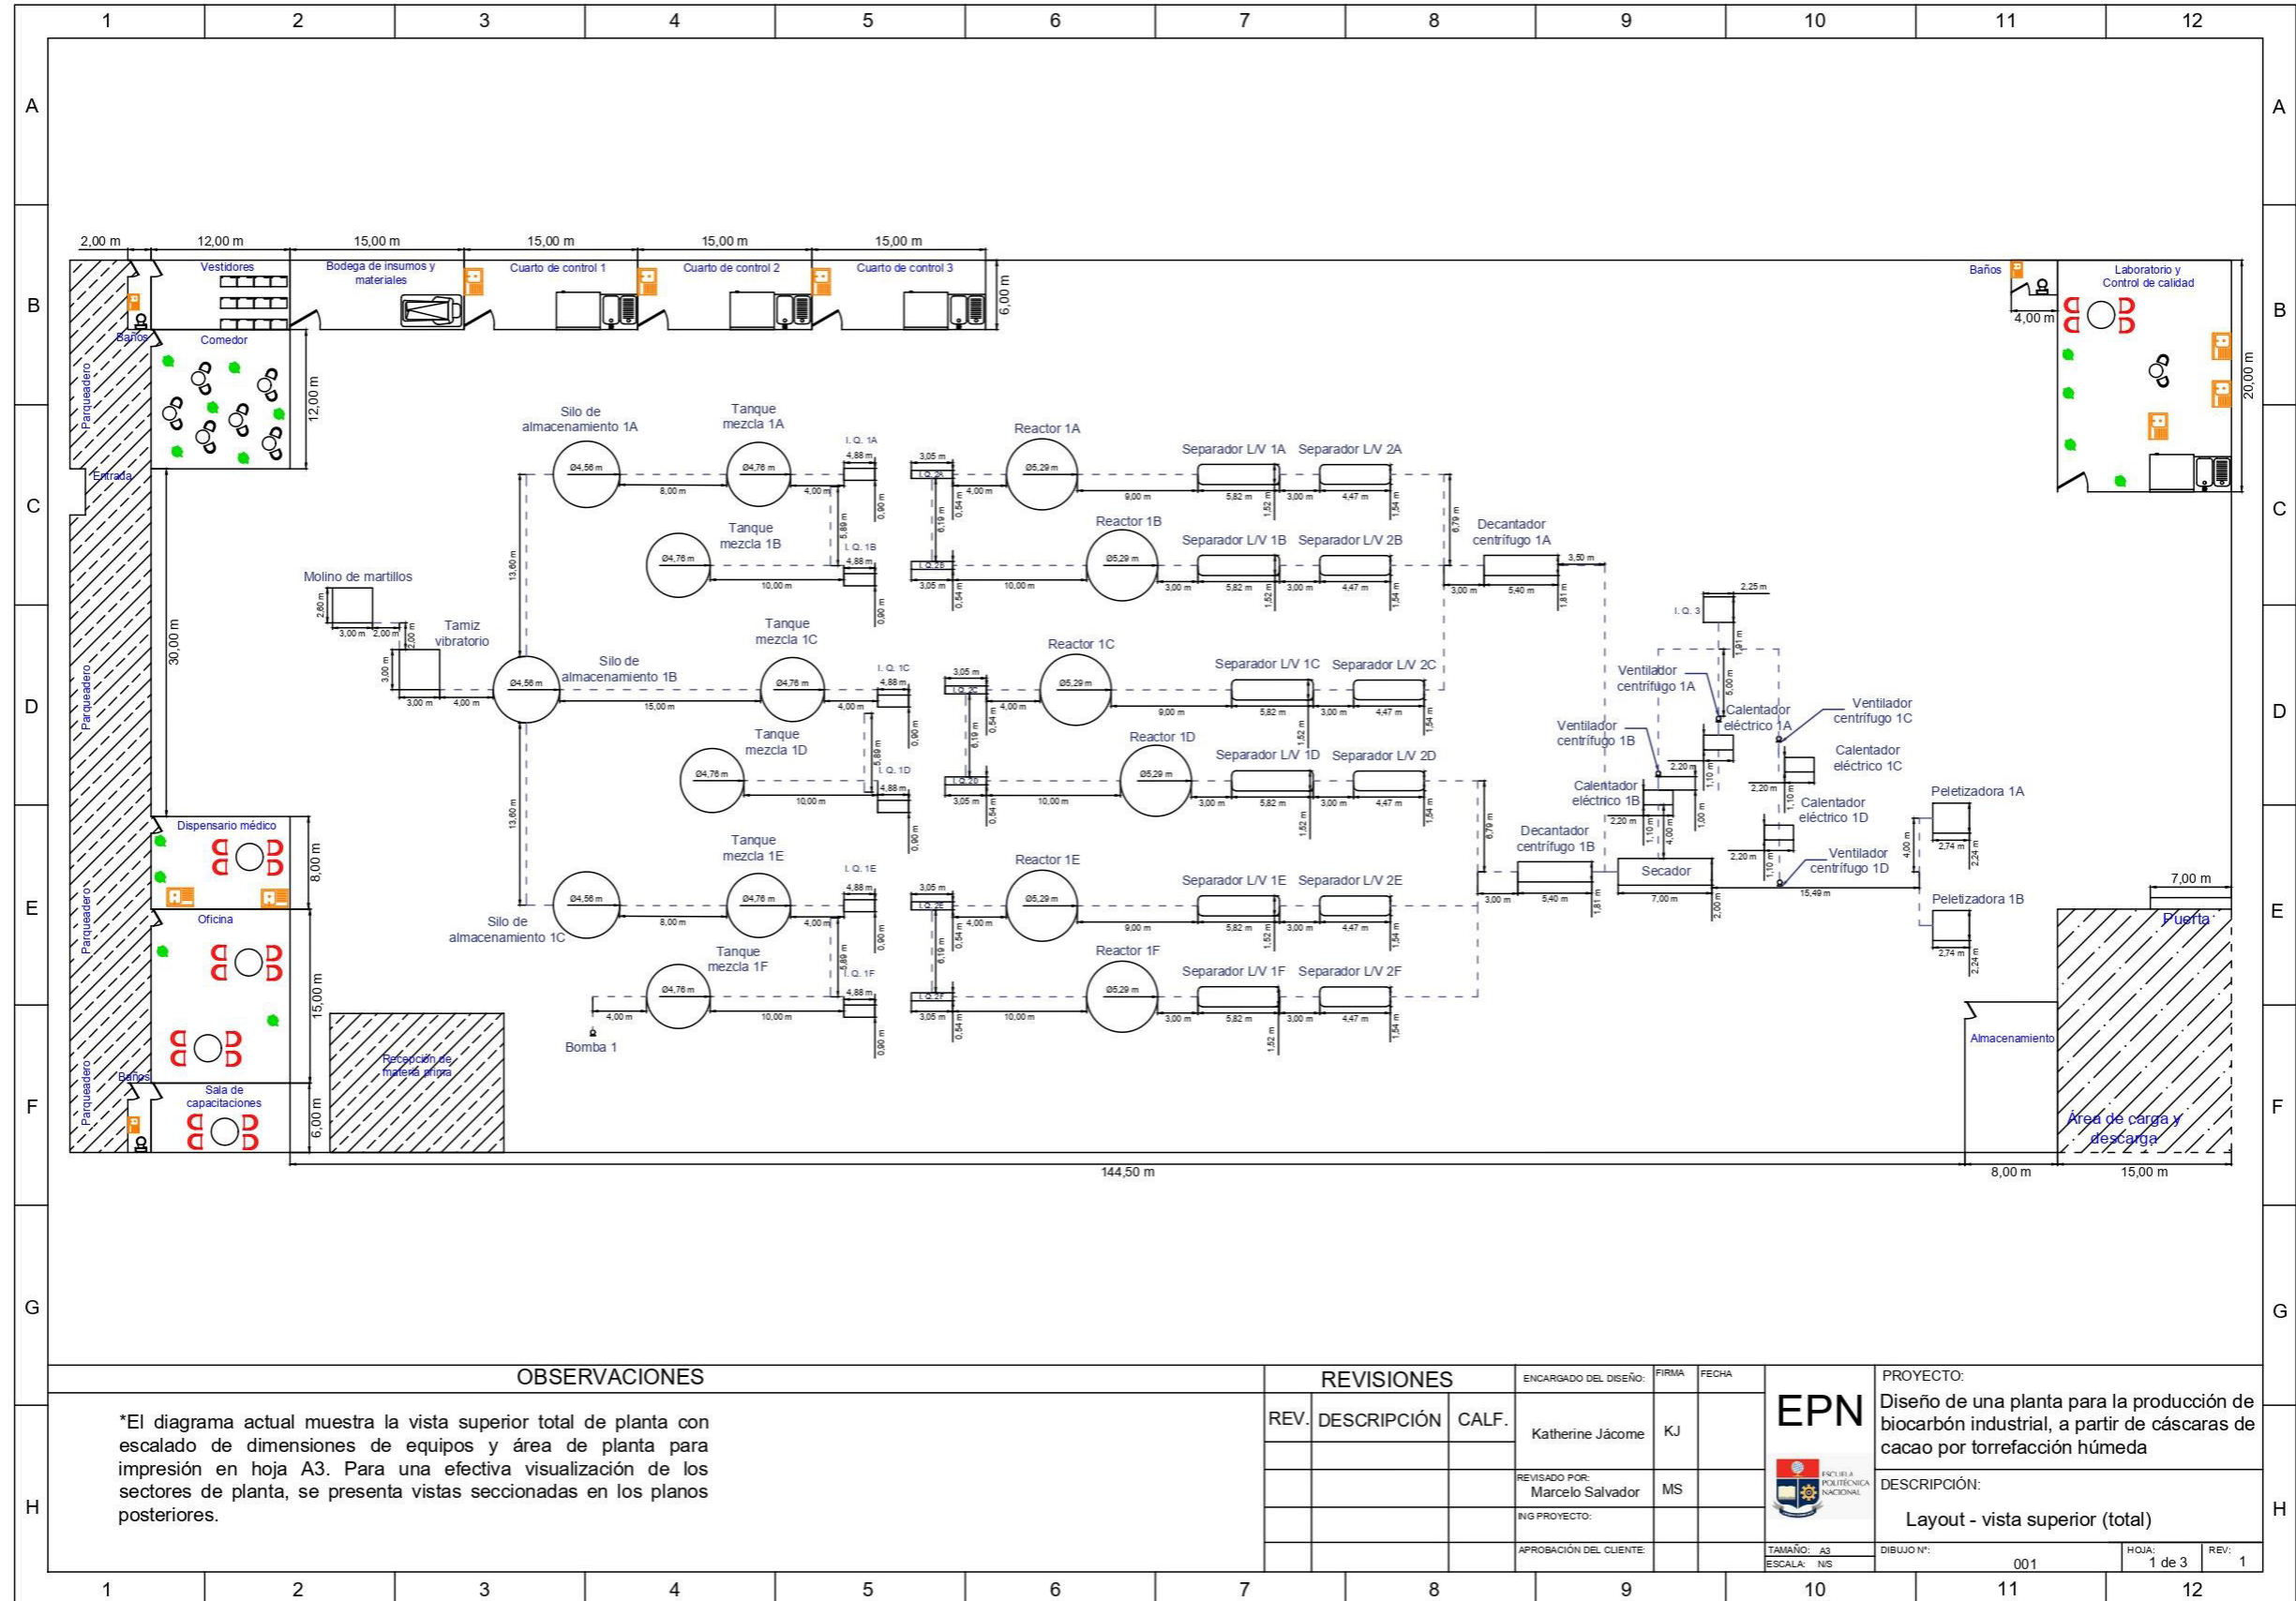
Layout de la planta para la producción de biocarbón a partir de cáscaras de cacao. Plano 1
